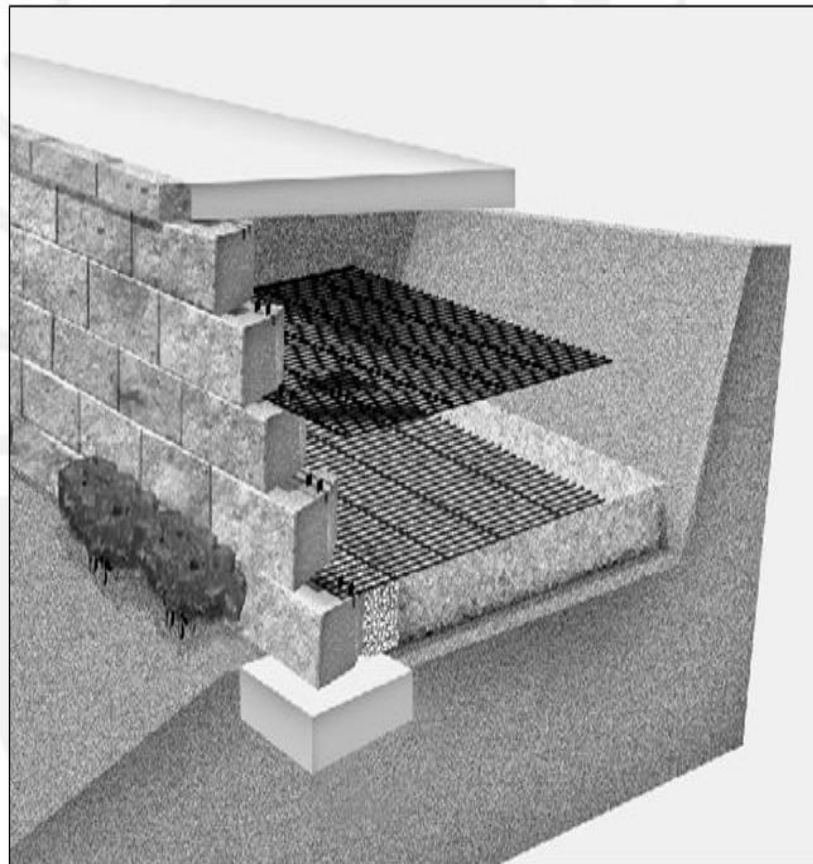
Ejemplo de un sistema con fachada de bloques de concreto prefabricados (Tensar, 2013)
